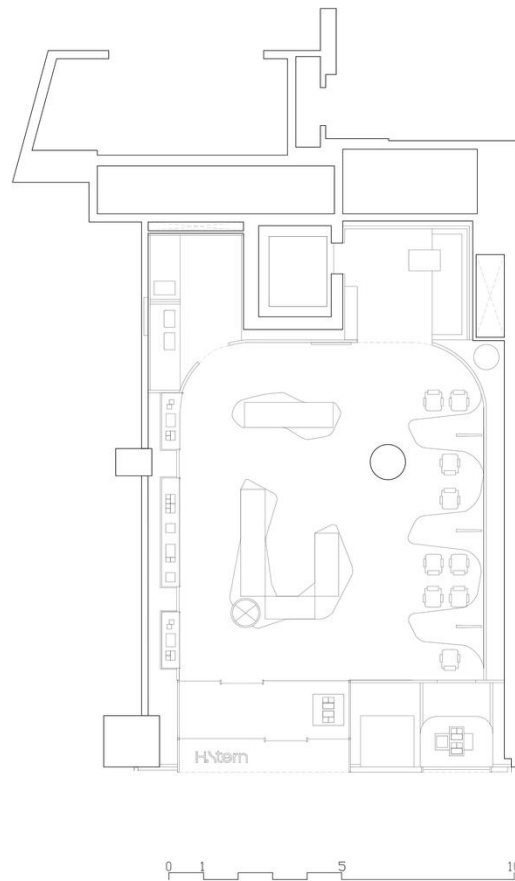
Planta baixa do primeiro pavimento da H. Stern® unidade Nova Iorque
